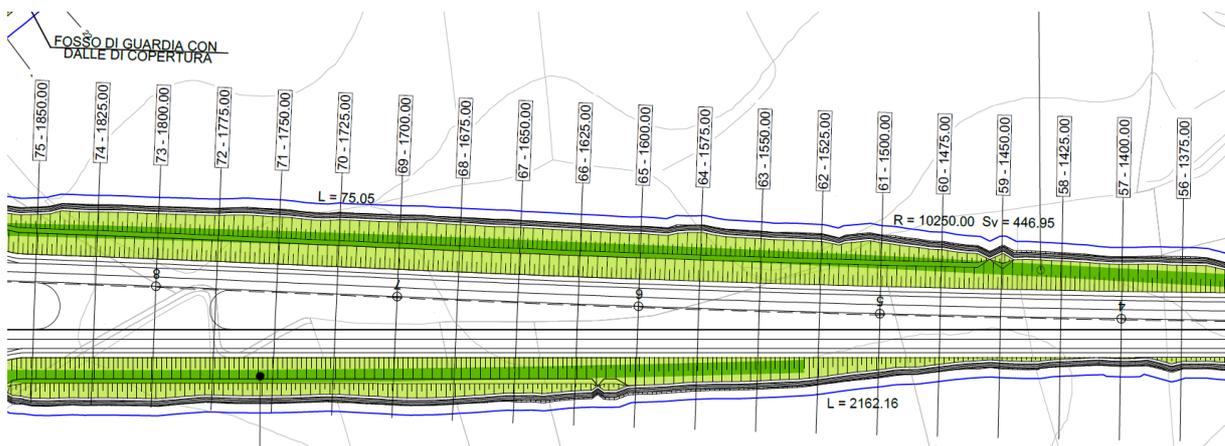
Sopra stralcio dalla planimetria di dettaglio interventi opere a verde di tratto in rilevato stradale di progetto superiore a 4 mt (da progr. 1+375,00 a 1+850,00).
